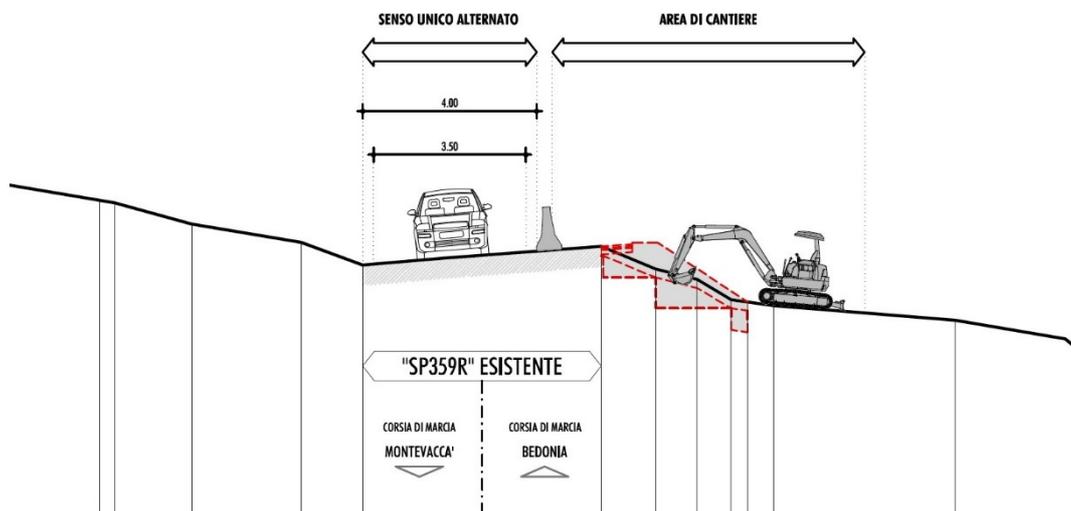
TRATTO 2, FASE 1: TRAFFICO SU CORSIA DI MONTE (ESTRATTO DALL'ELAB. PD.04.04)
